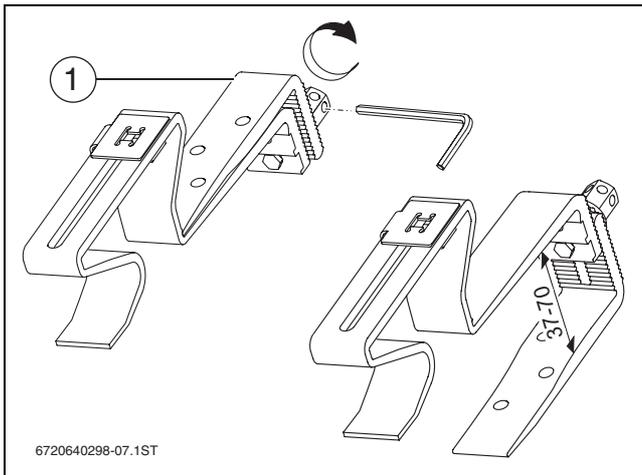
Dachhaken-Unterteil drehen, Maße in mm
